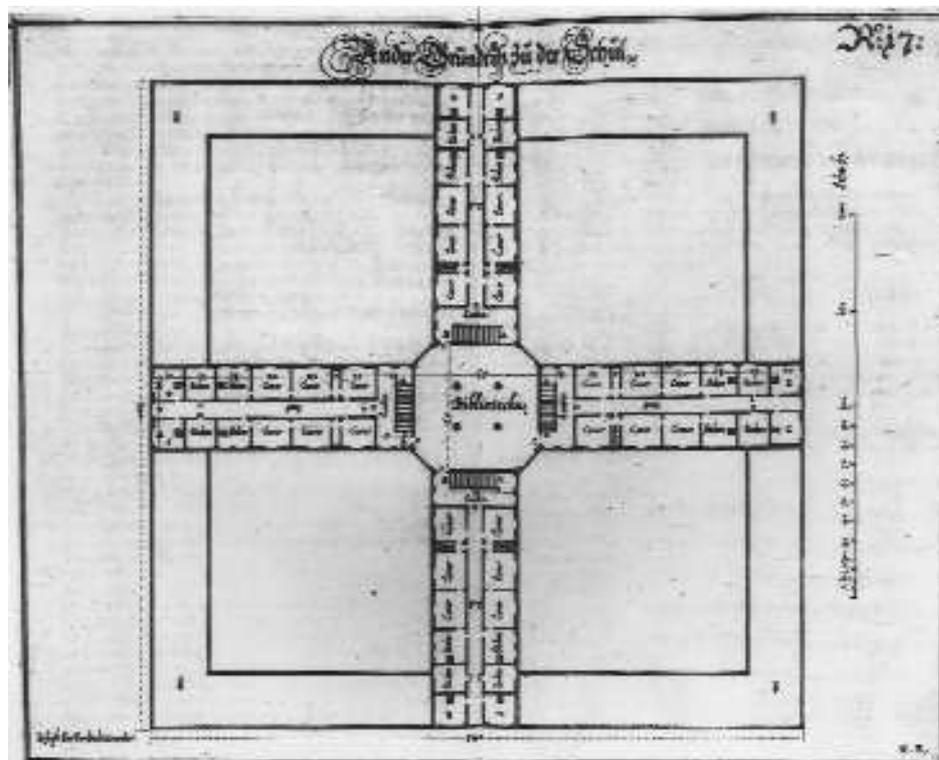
Furttendach d. Ä.: Schul- oder Akademiegebäude, Grundriß der Obergeschosse, 1635
